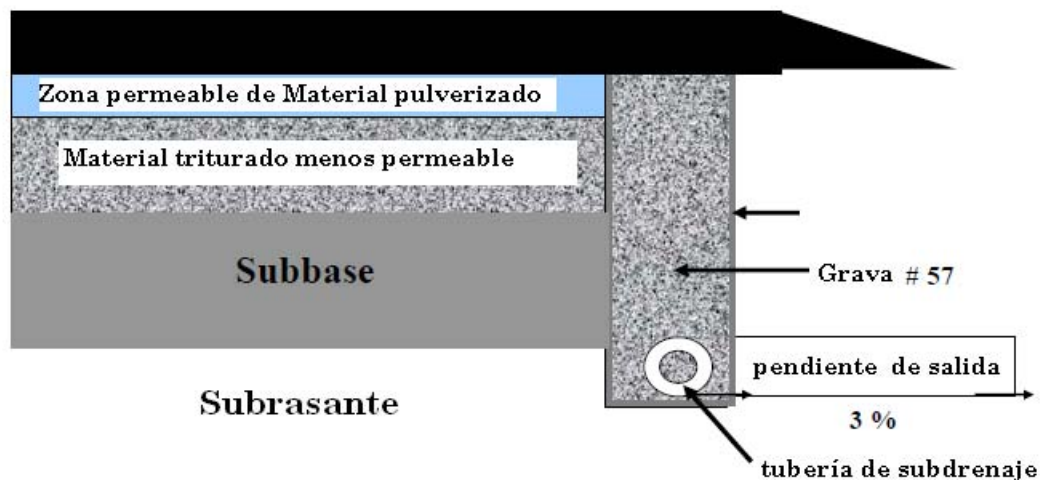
Esquema de un sistema típico de subdrenaje lateral en un pavimento de concreto triturado (Asphalt Institute, 2008).
